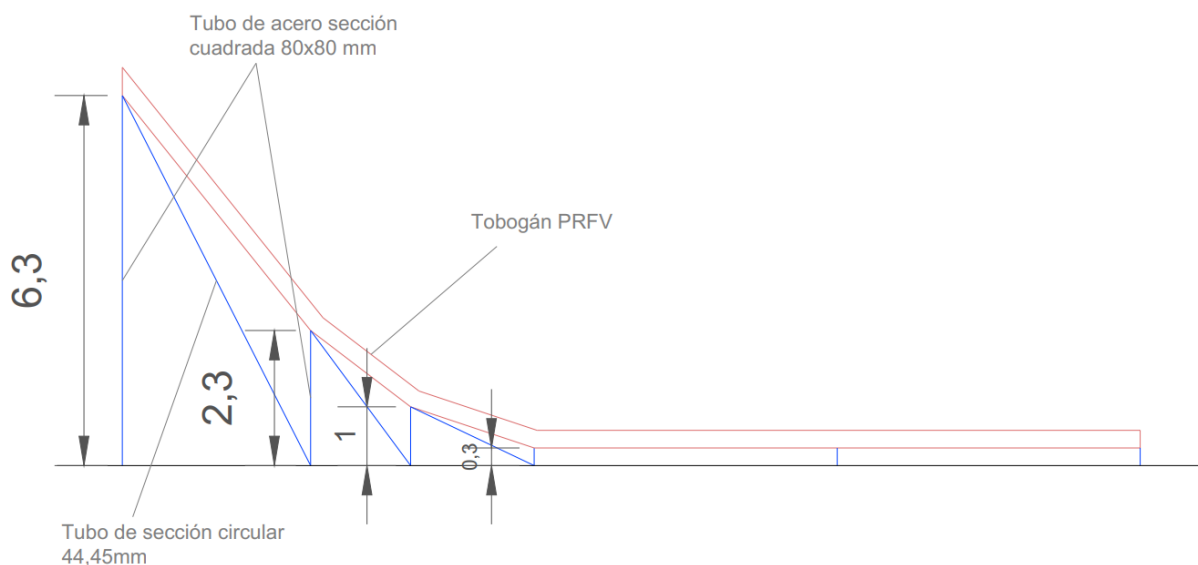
Esquema de la estructura propuesta (fuente: elaboración propia)
